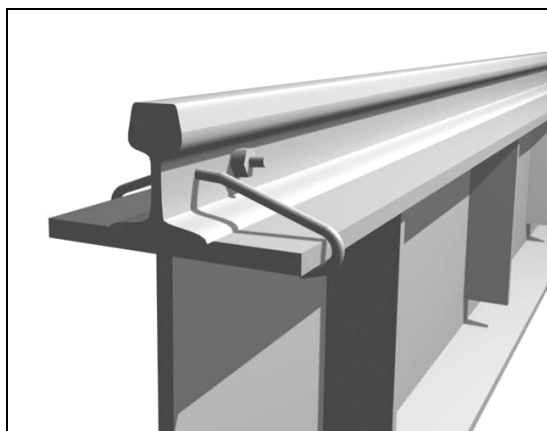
Крепление железнодорожного рельса крючьями к верхнему поясу подкрановой балки
